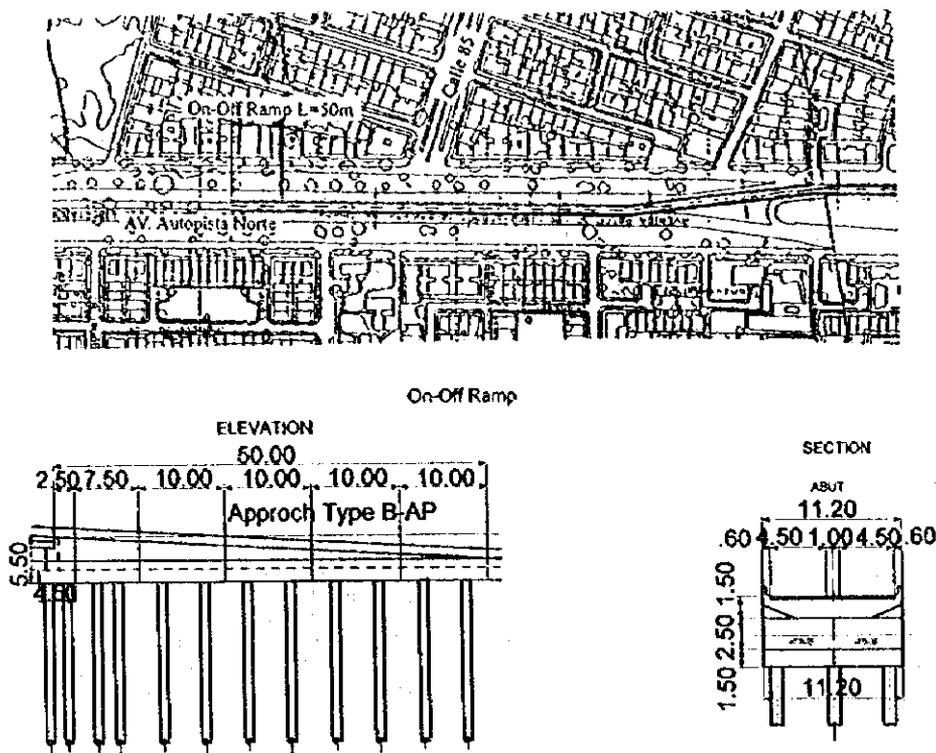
Rampa de entrada y salida sobre la Autopista Norte - Calle 86
